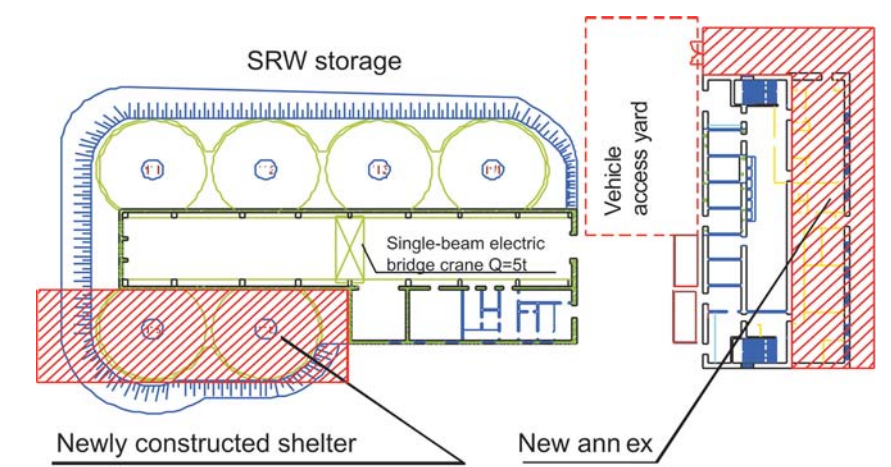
Схема расположения зданий и укрытий для размещения оборудования цеха ЖРО
